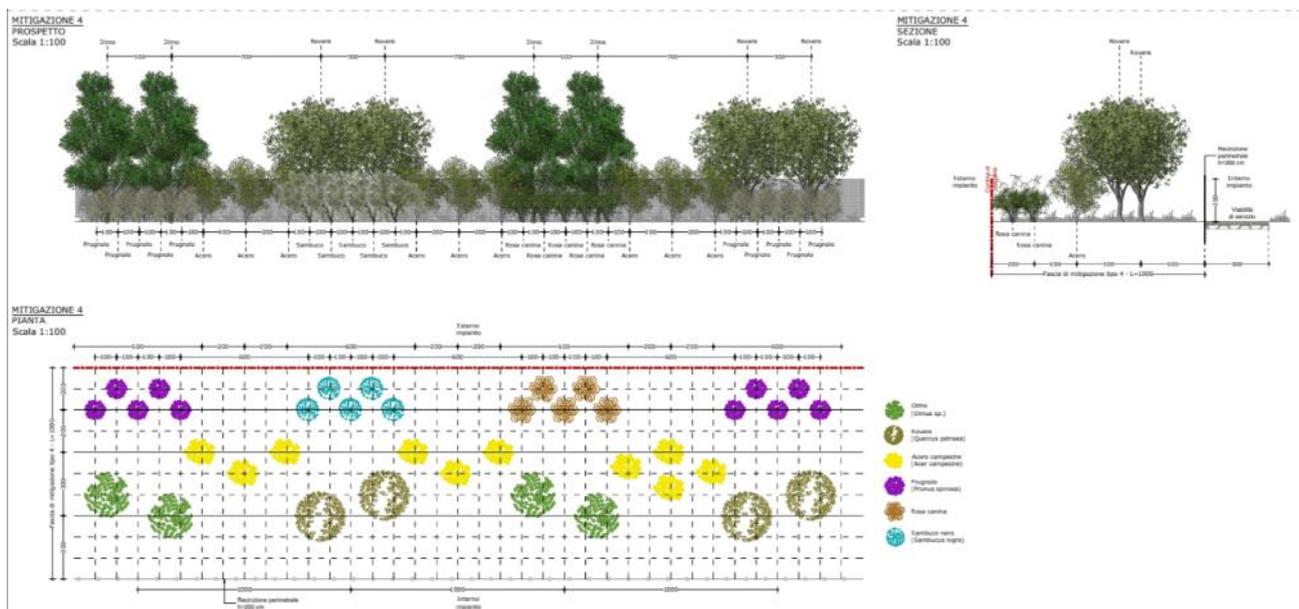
Pianta, sezione e prospetto della mitigazione di tipo 4 (da elab. di progetto)
